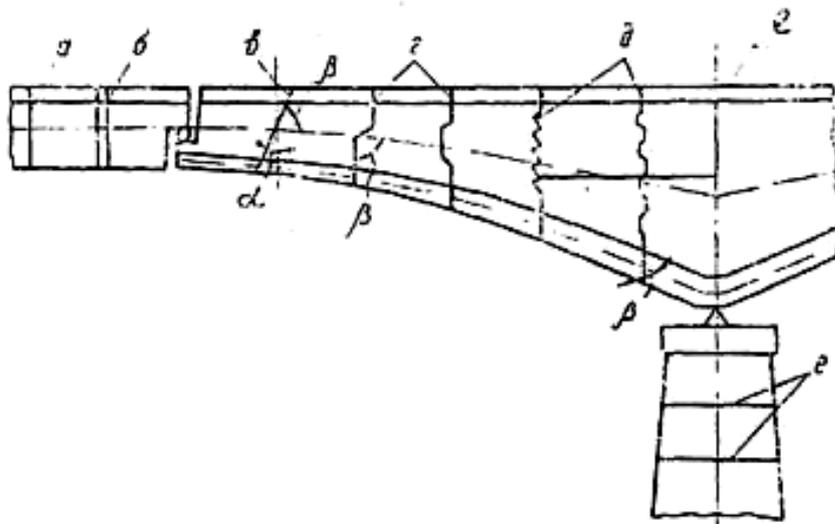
Виды стыков: а-плоские вертикальные; б-плоские вертикальные с диафрагмой в стыке; в-плоские наклонные; г-плоские с уступом; д-зубчатые; е-плоские горизонтальные
